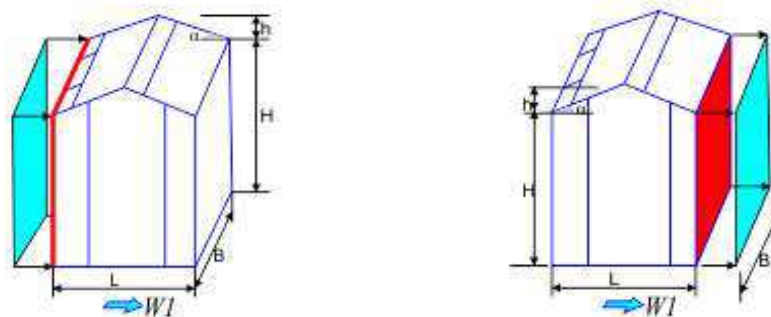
Схема приложения ветровой нагрузки на боковые стены
